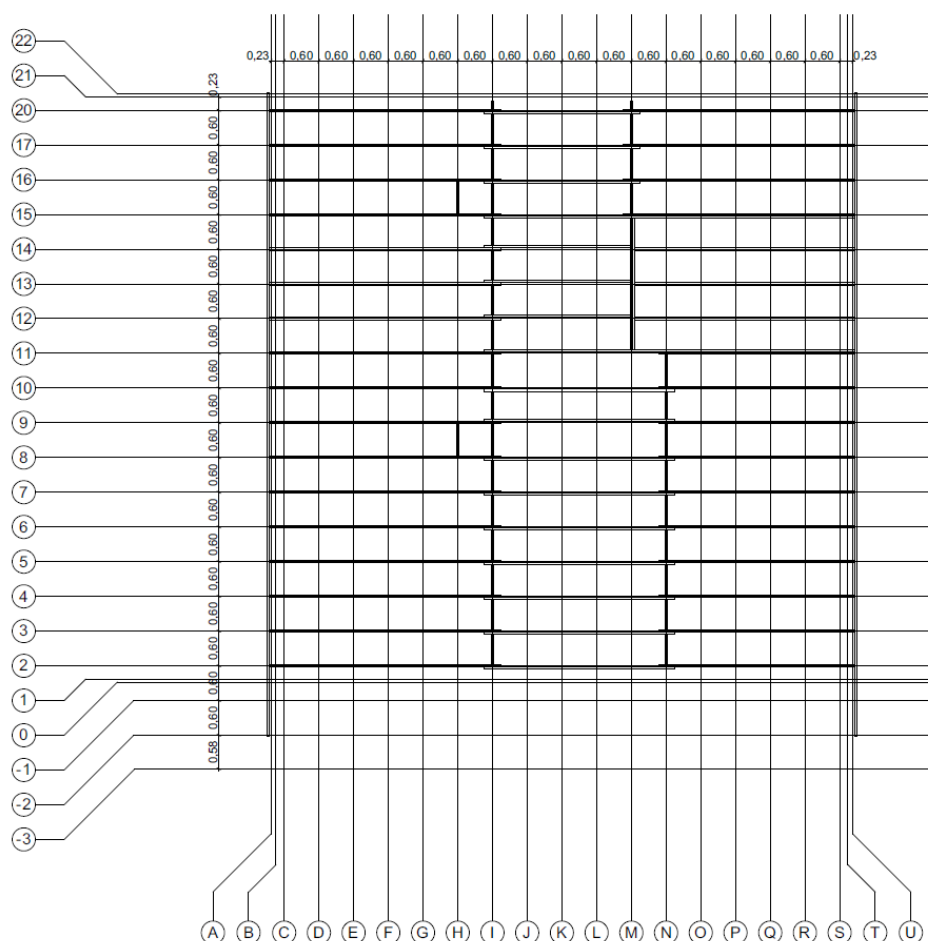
Estrutura do pavimento do tecto do piso 1 e grelha estrutural.
